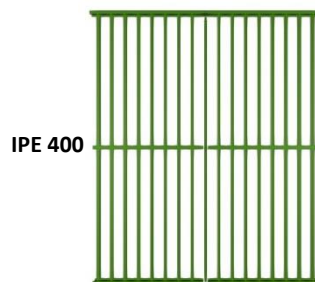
Forjado unidireccional con viguetas metálicas. Fuente: CYPE 3D.
